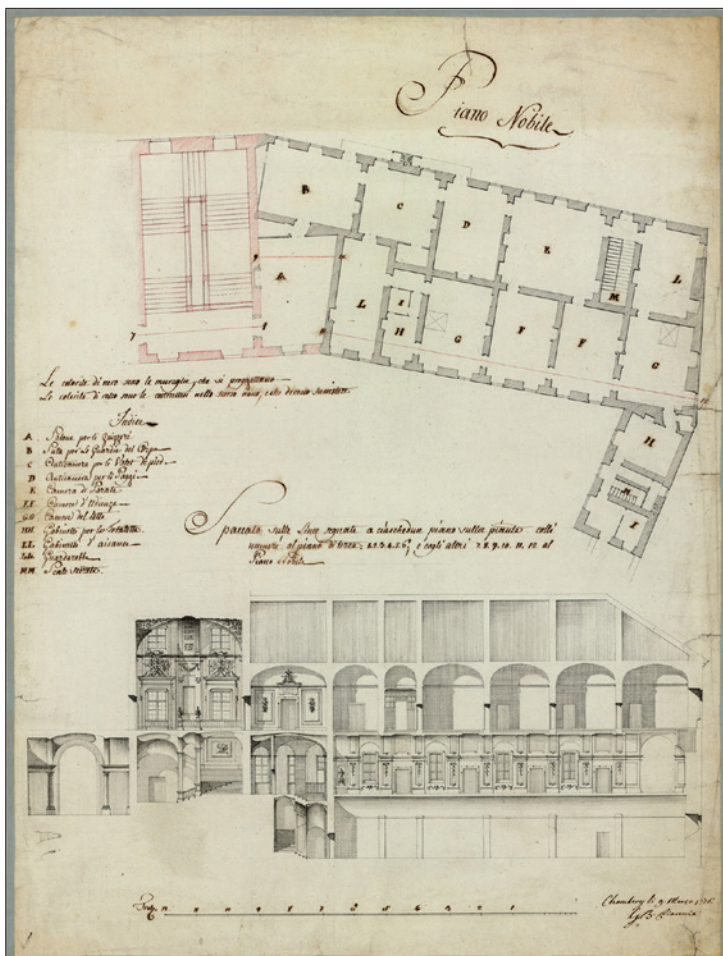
Projet d'aménagement du Vieux Pavillon, 1775, premier étage et coupe générale. ASTO, Pallazi Reali, n. 014-002925.
